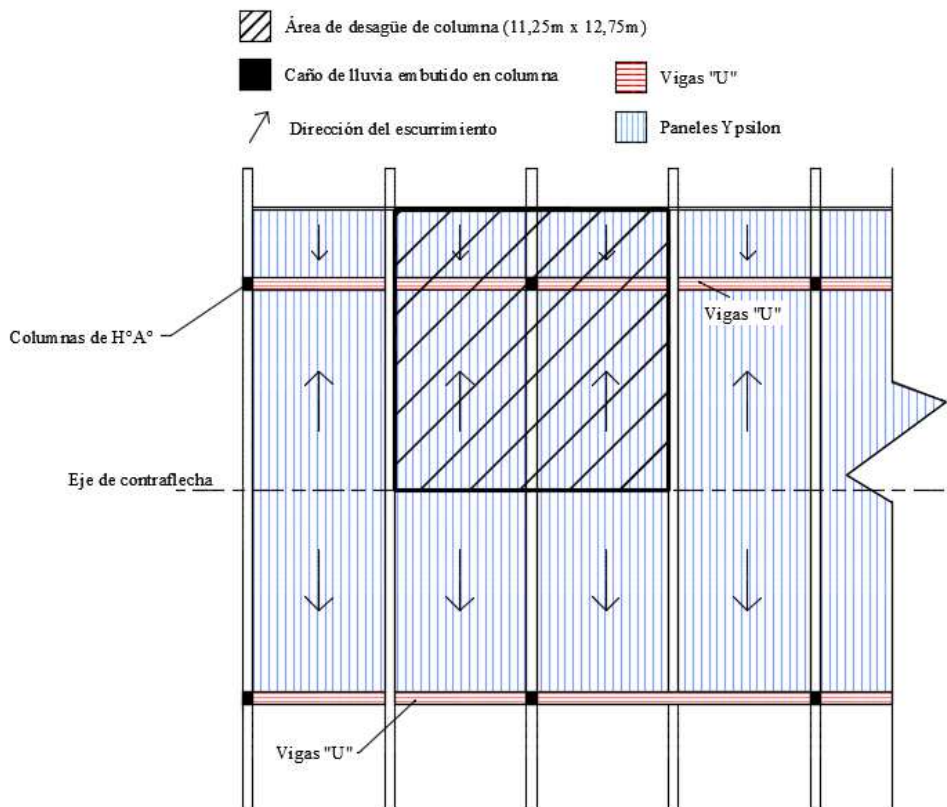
Vista en planta del área de desagüe por caño de lluvia. Fuente: Autor
